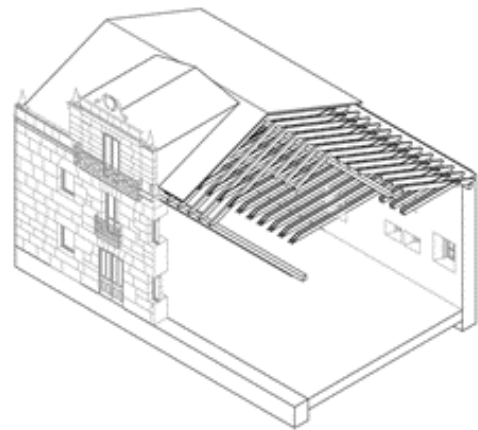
Axonometría explicativa de la colocación de los tirantes de madera en los pares de la cubierta.
